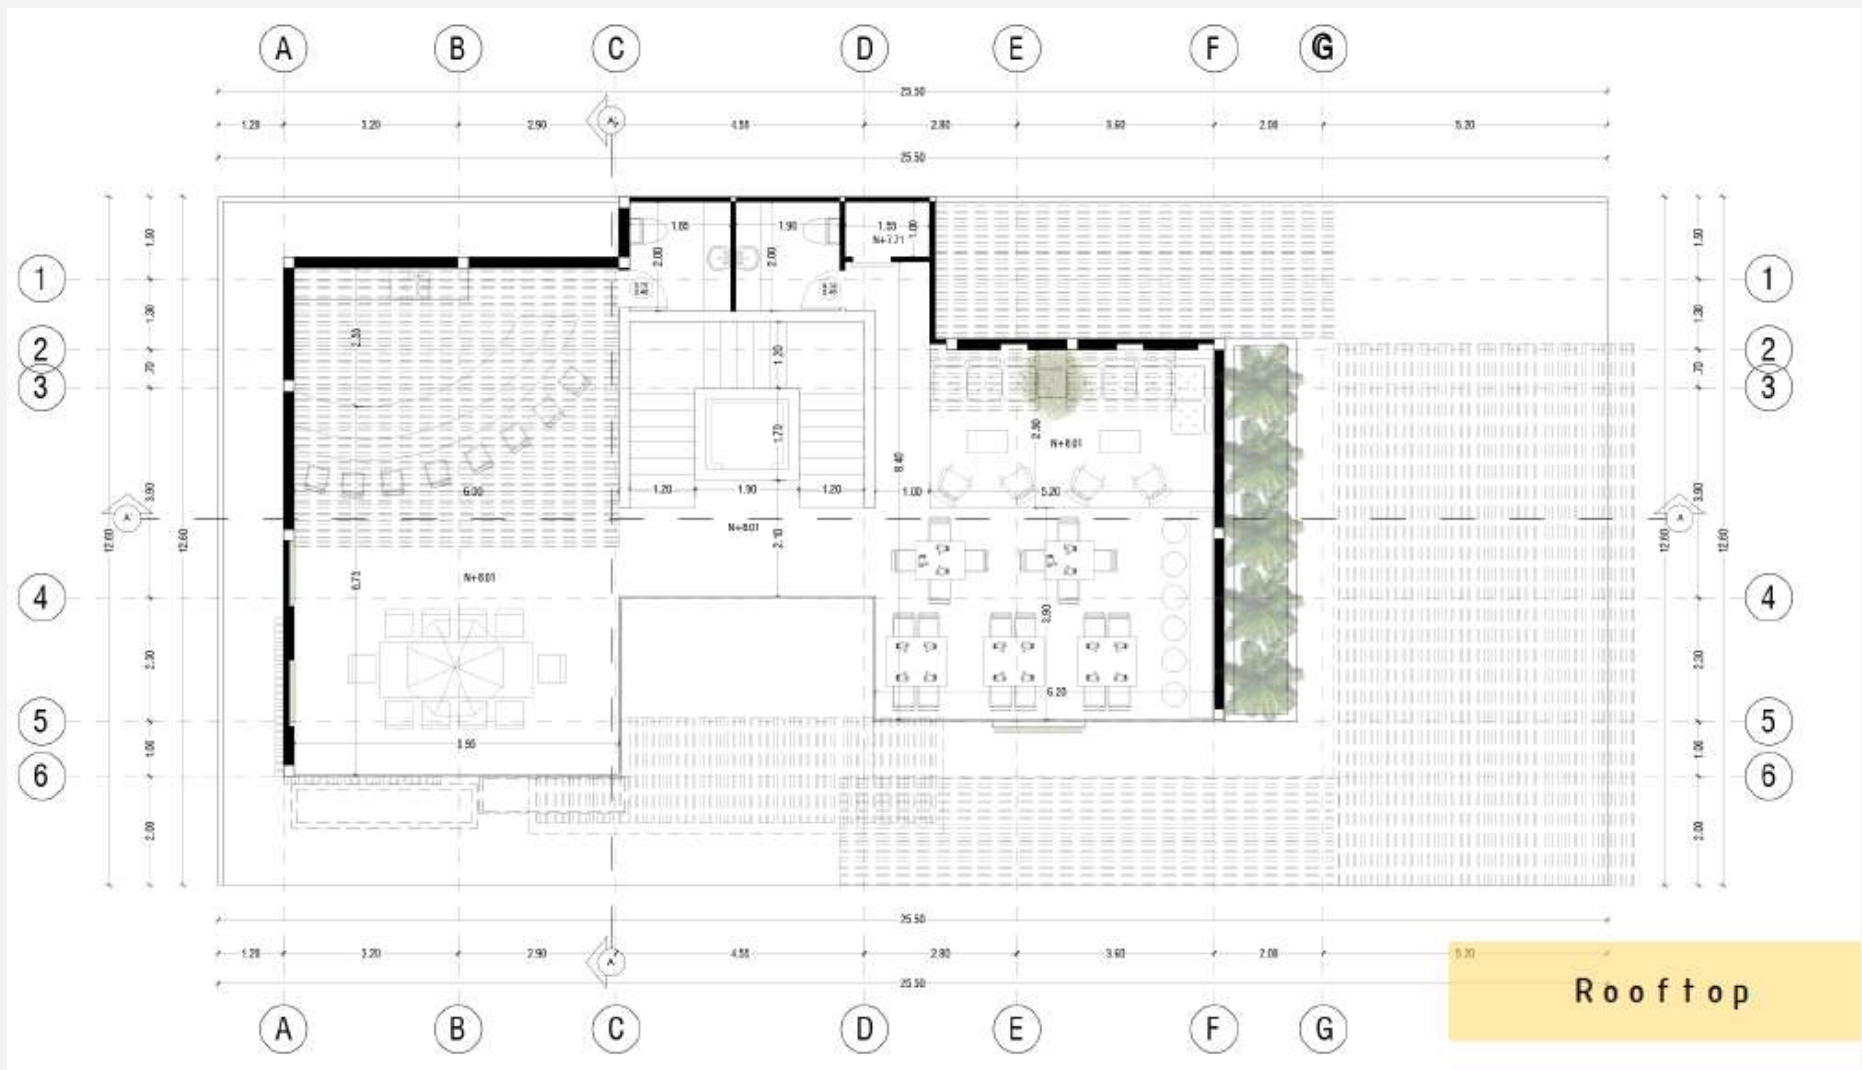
Planos arquitectónicos (Rooftop). Fuente: Andrea Balcázar (2018)
